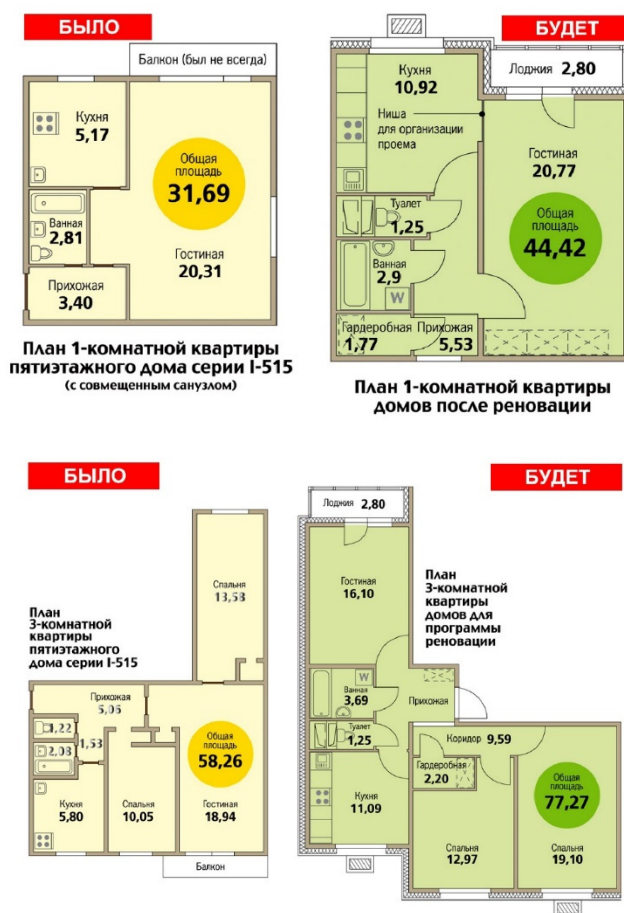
Планировочные решения капитальной реконструкции до 2017 г.
